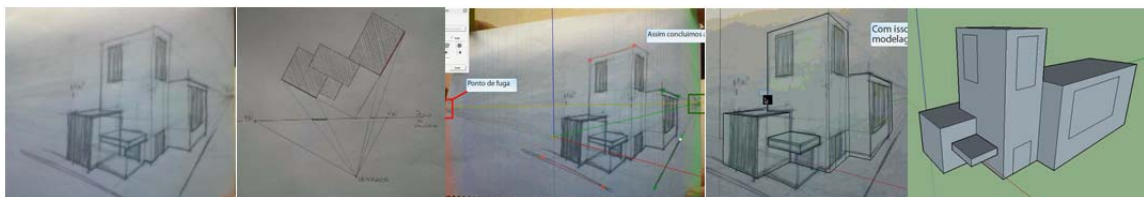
Croqui, Planta Baixa, ajuste dos eixos, croqui e modelo digital. Fonte: autor
